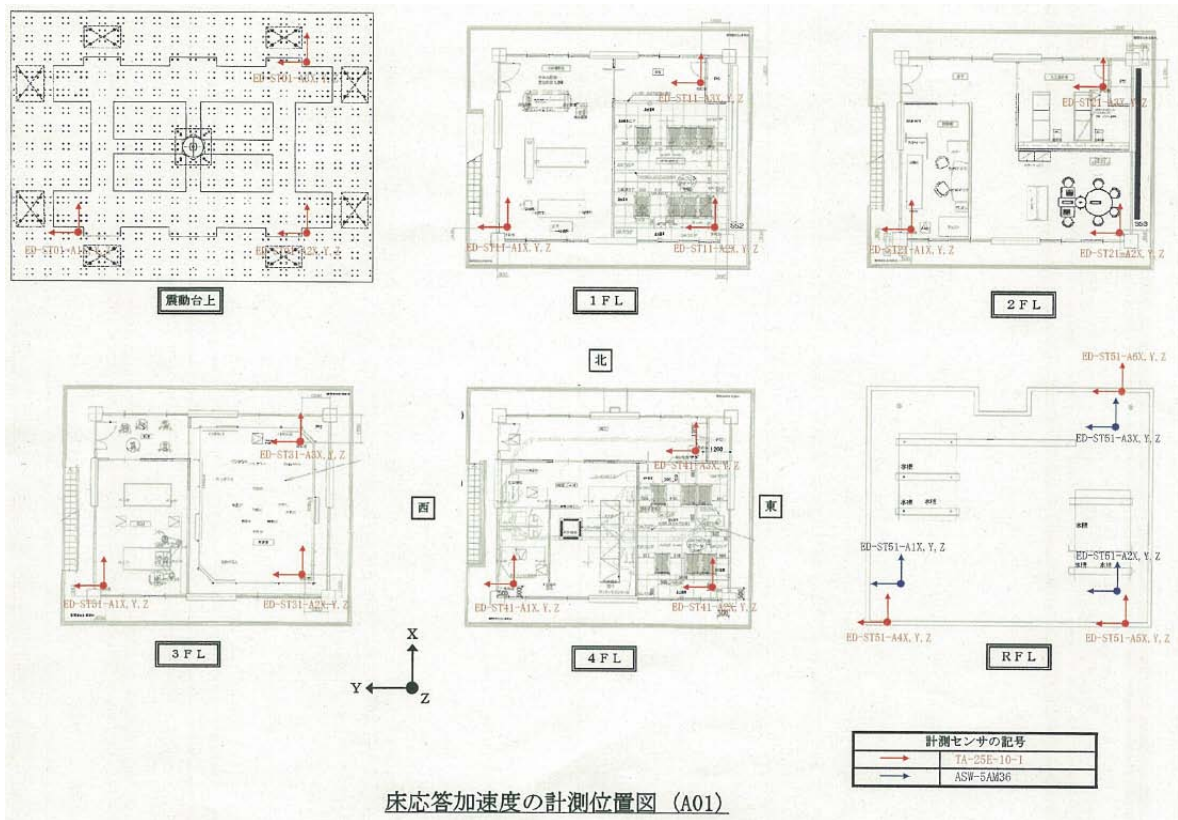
試験体の平面図及び防災科研センサの設置箇所
